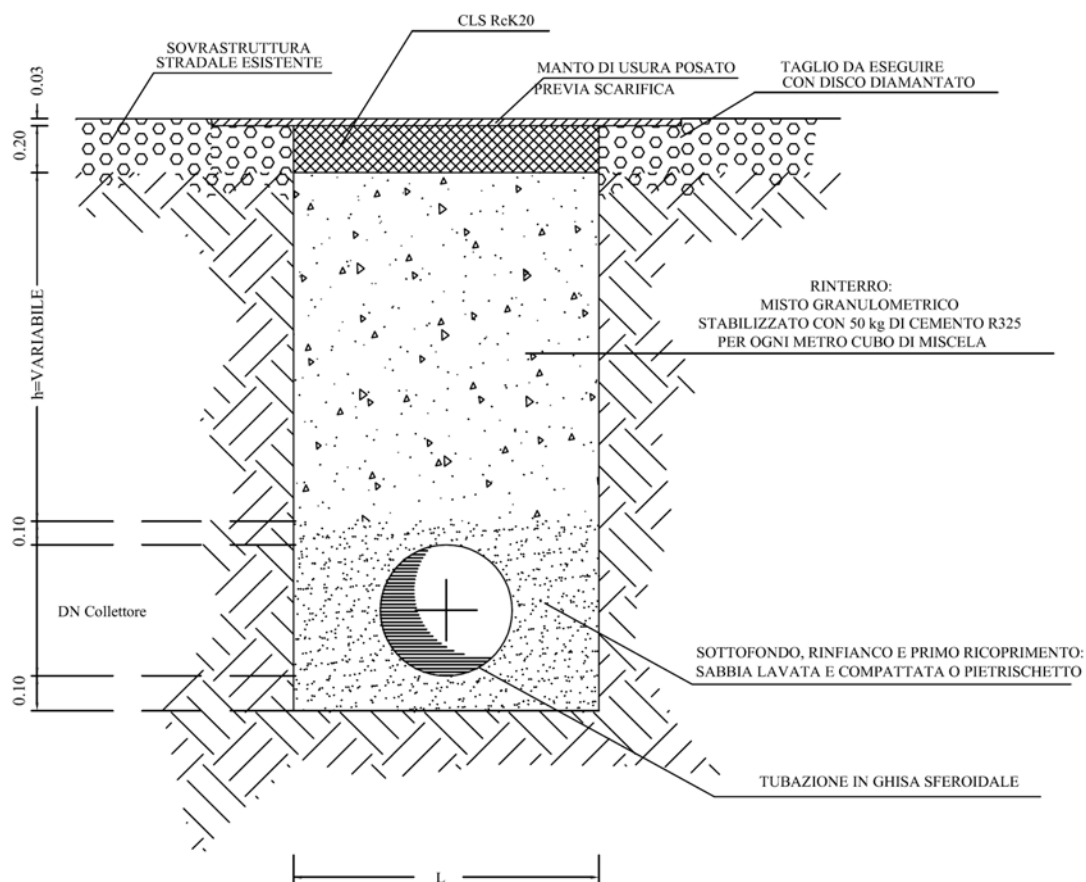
Sezione tipo di posa delle condotte su strada asfaltata
